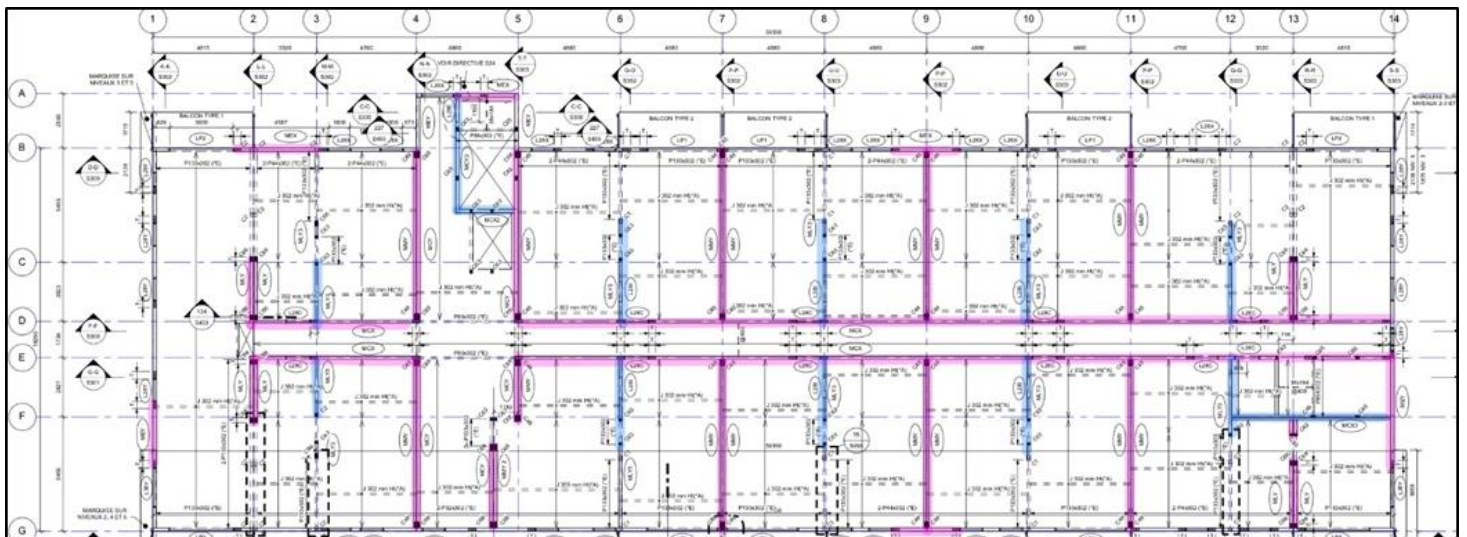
Croquis de la trame structurale du bâtiment tel que construit
